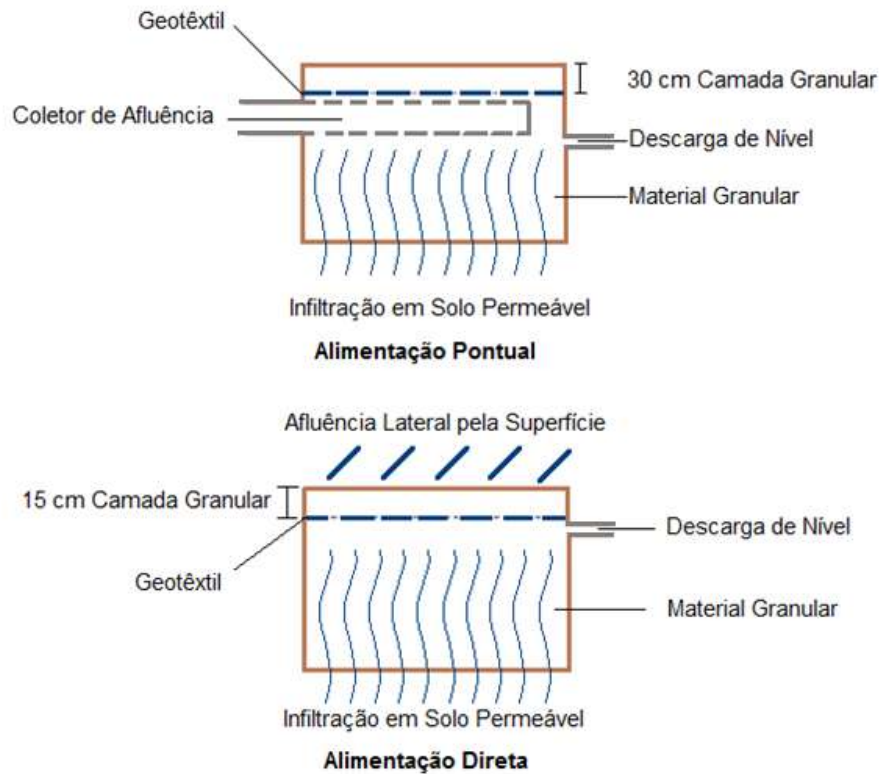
Tipos de alimentação de trincheiras de infiltração (Adaptado de Ballard *et al.* (2007))
